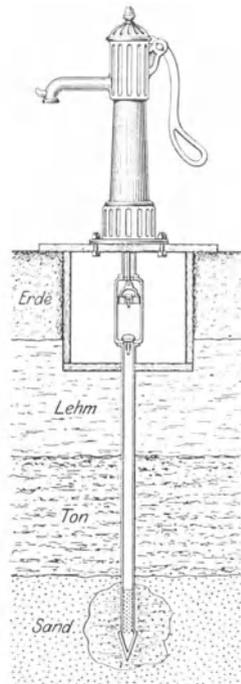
Abessinierbrunnen mit eingebautem Zylinder.
